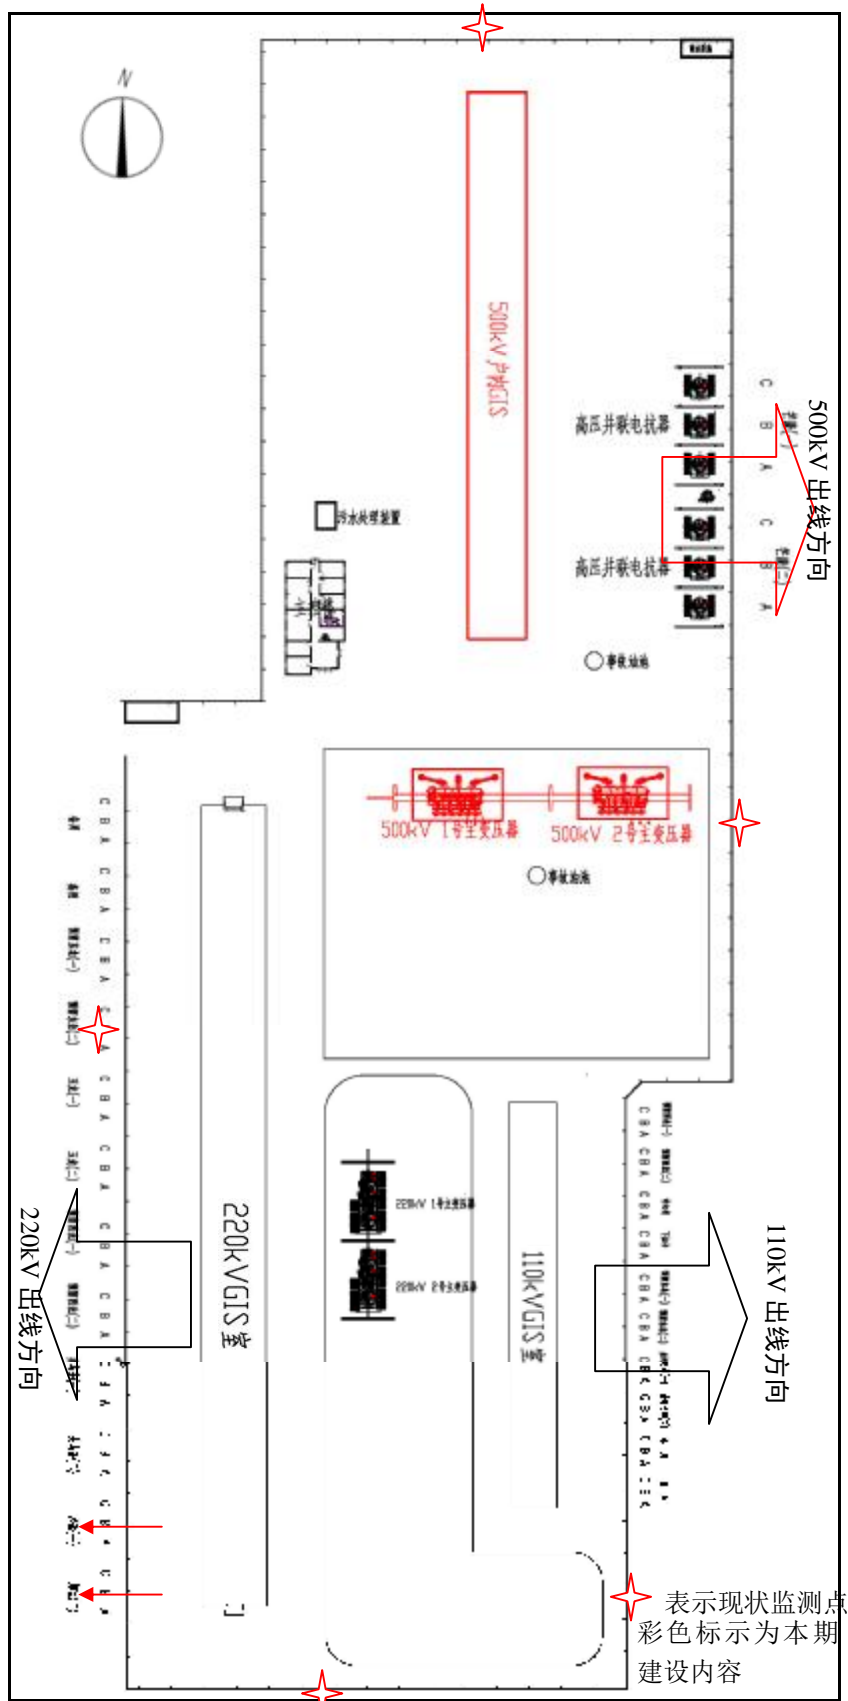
昌都 500kV 变电站站区总平面布置图
